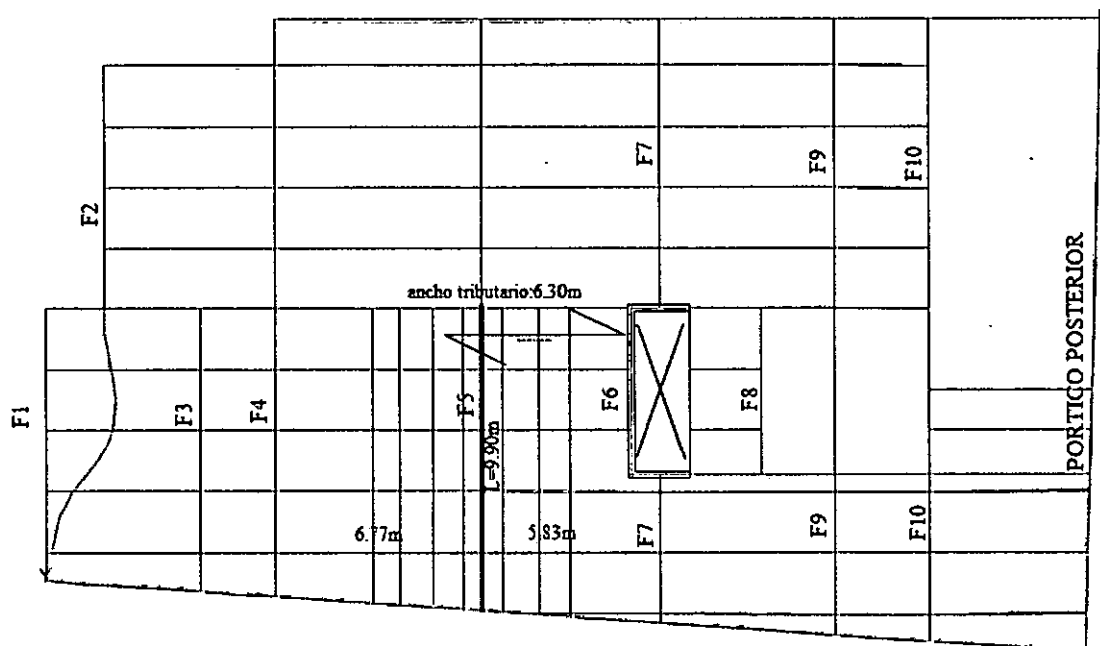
Ubicación en planta del ancho tributario para la viga de diseño
